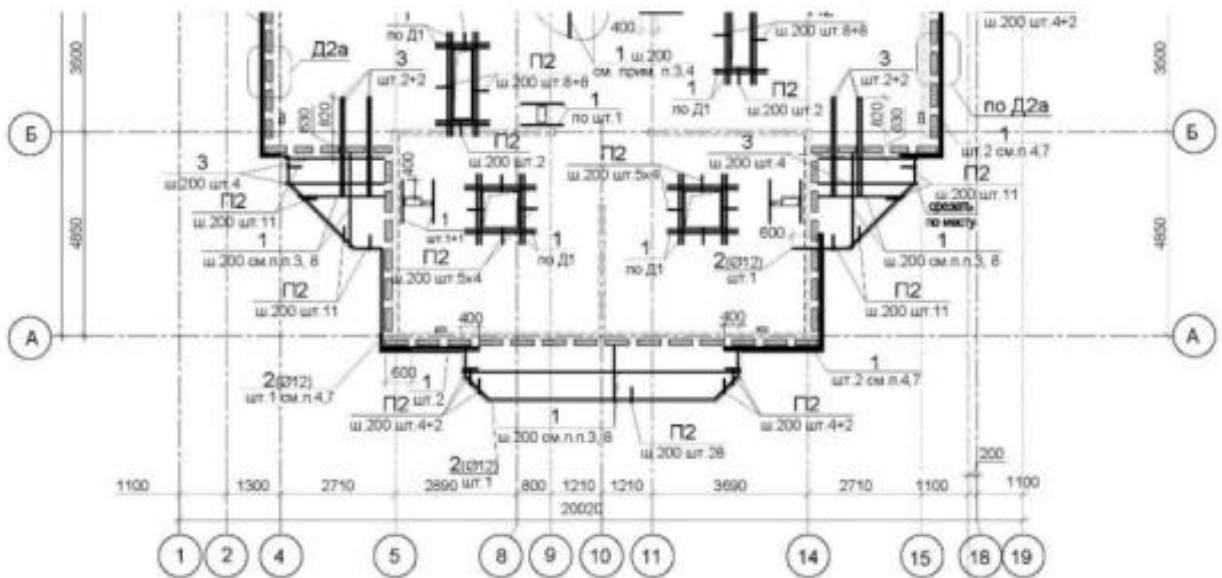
Фрагмент схеми армування диска перекриття з пристроєм перфорації під термовклади.
